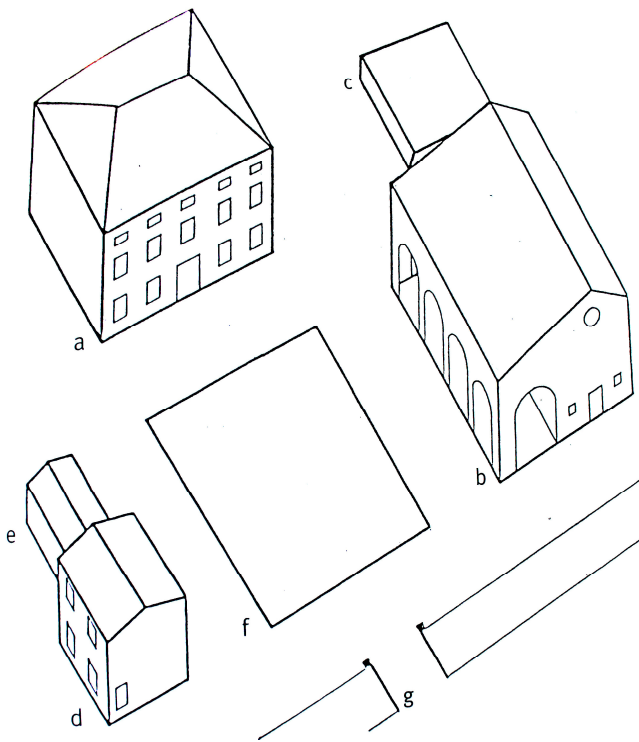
Corte rurale aperta [da Dino Niccolini, La corte rurale del Mantovano, Silvana, Milano, 1984]
